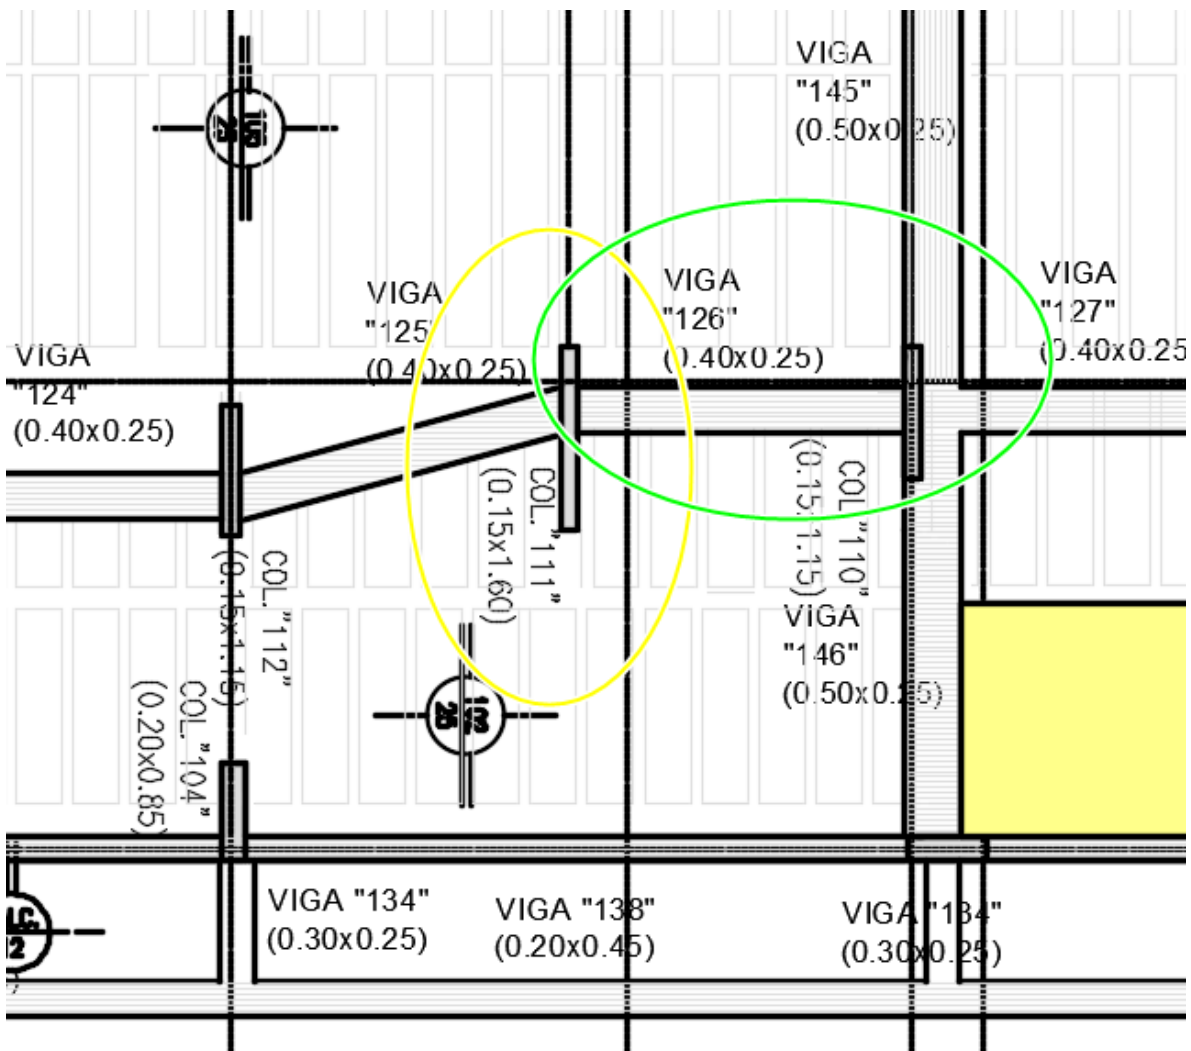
Planta estructural donde se señala los elementos a analizar.
